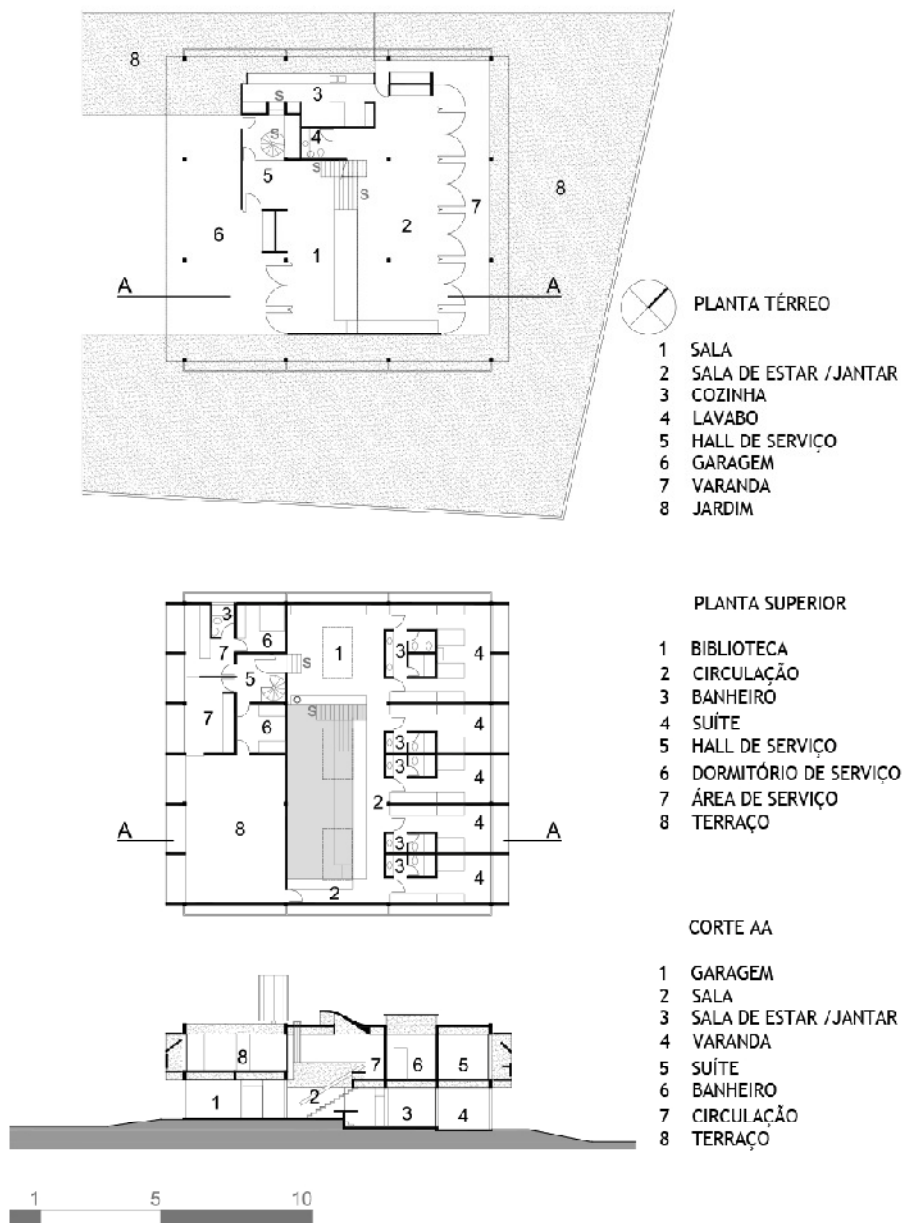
Plantas do pavimento térreo, superior e corte. Fonte: autora.
